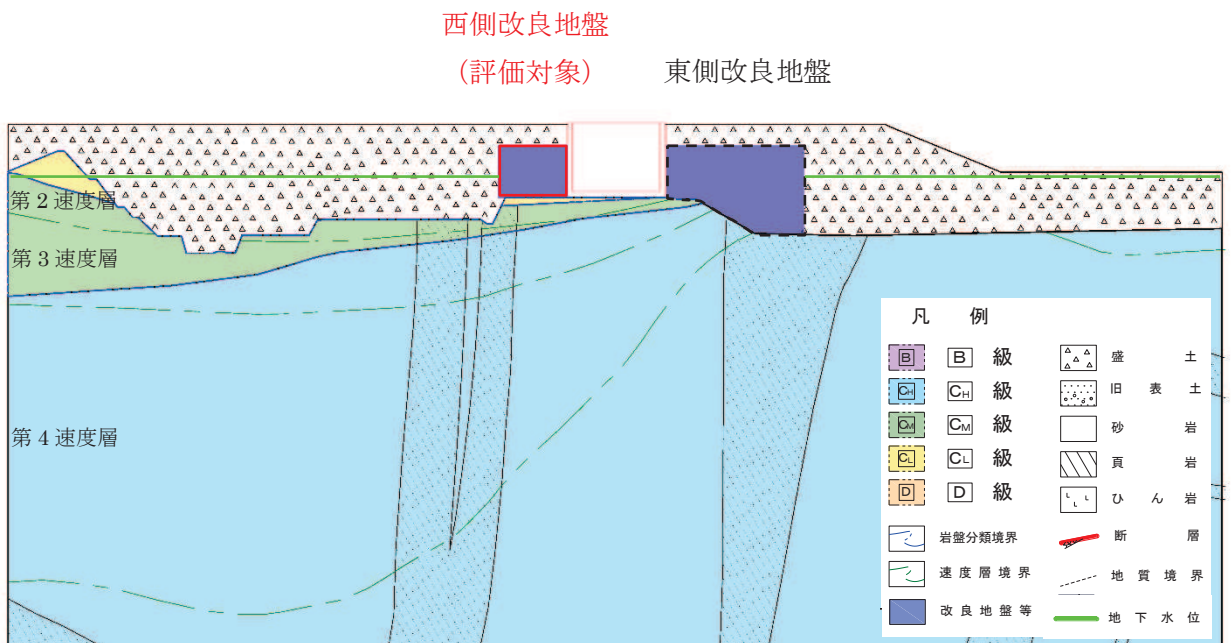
改良地盤の評価対象断面の地質断面図 (A-A 断面)
